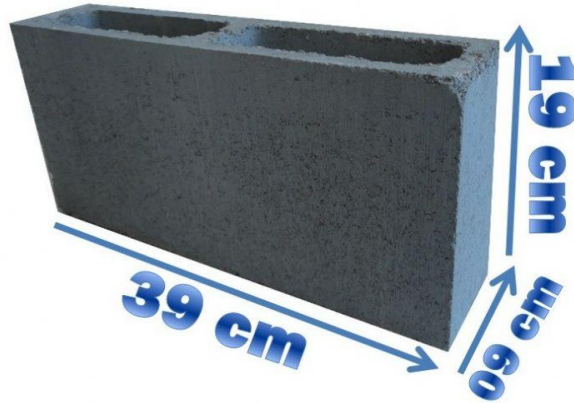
Bloco de cimento vazado para vedação - Módulo 10
